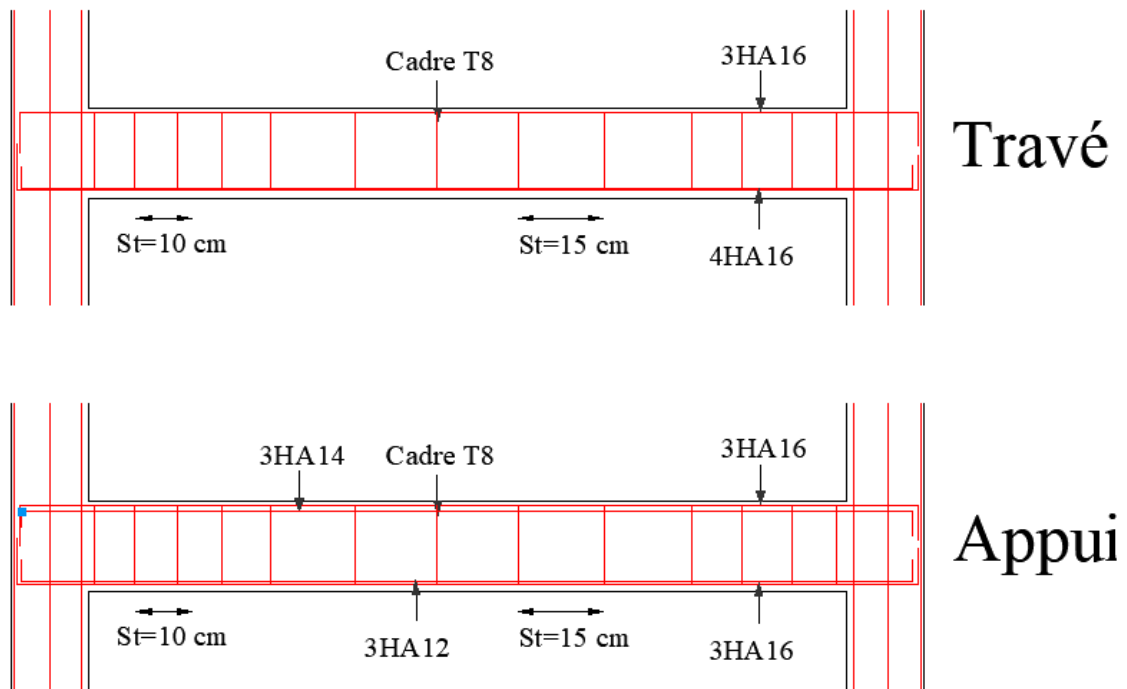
Schéma de ferrailage des poutres (Coupe).
